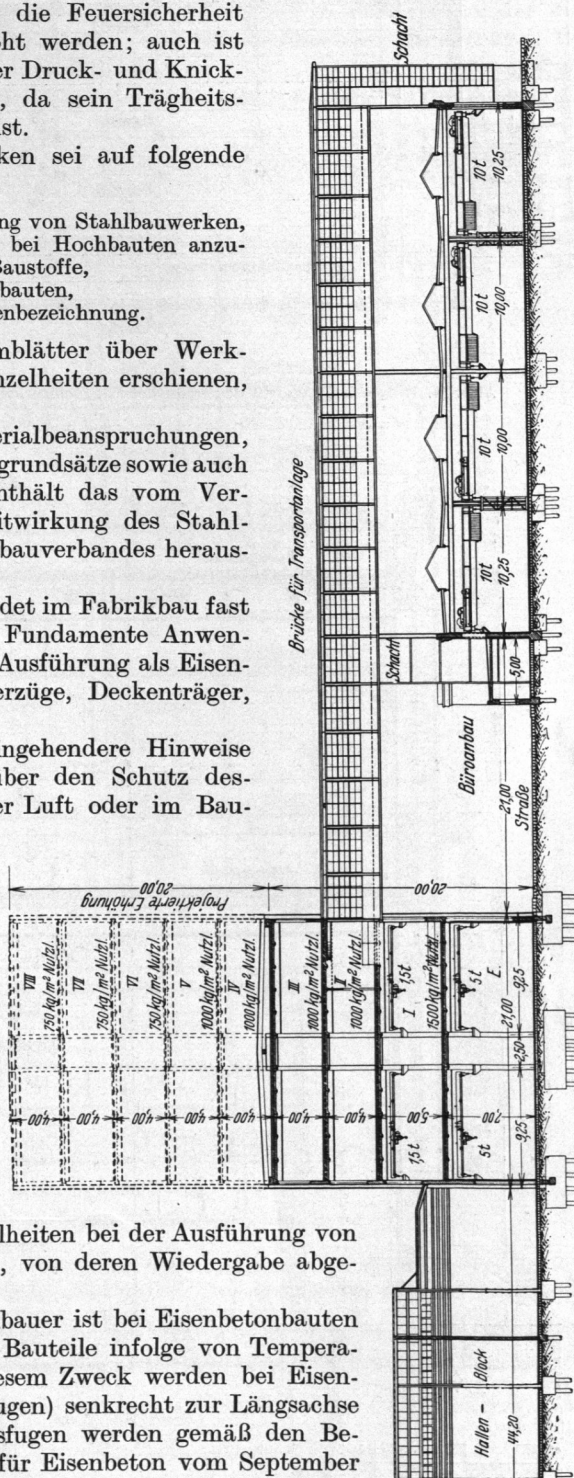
Stahlskelett-Stockwerksbau mit anschließendem Hallenblock und Transportbrücke nach einem benachbarten Hallenblock.
